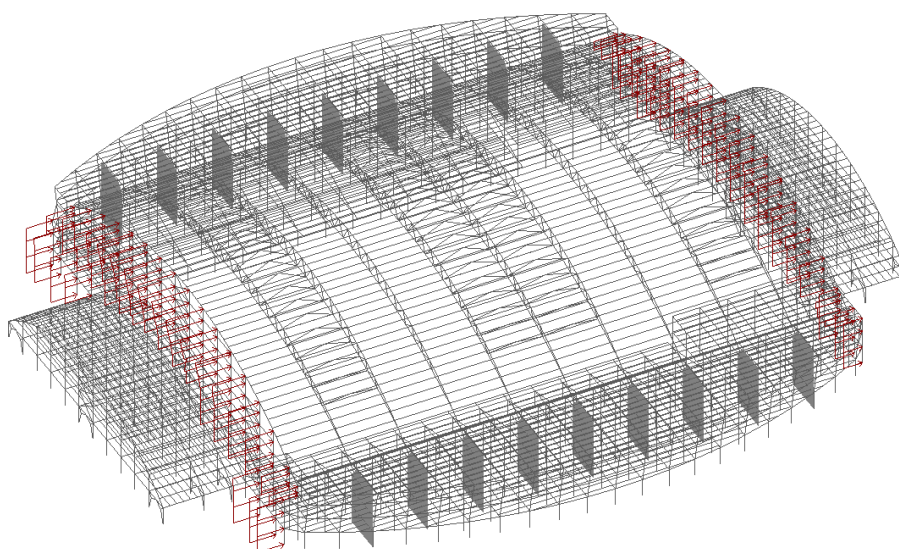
Схема приложения ветровой нагрузки на колонны блока А
